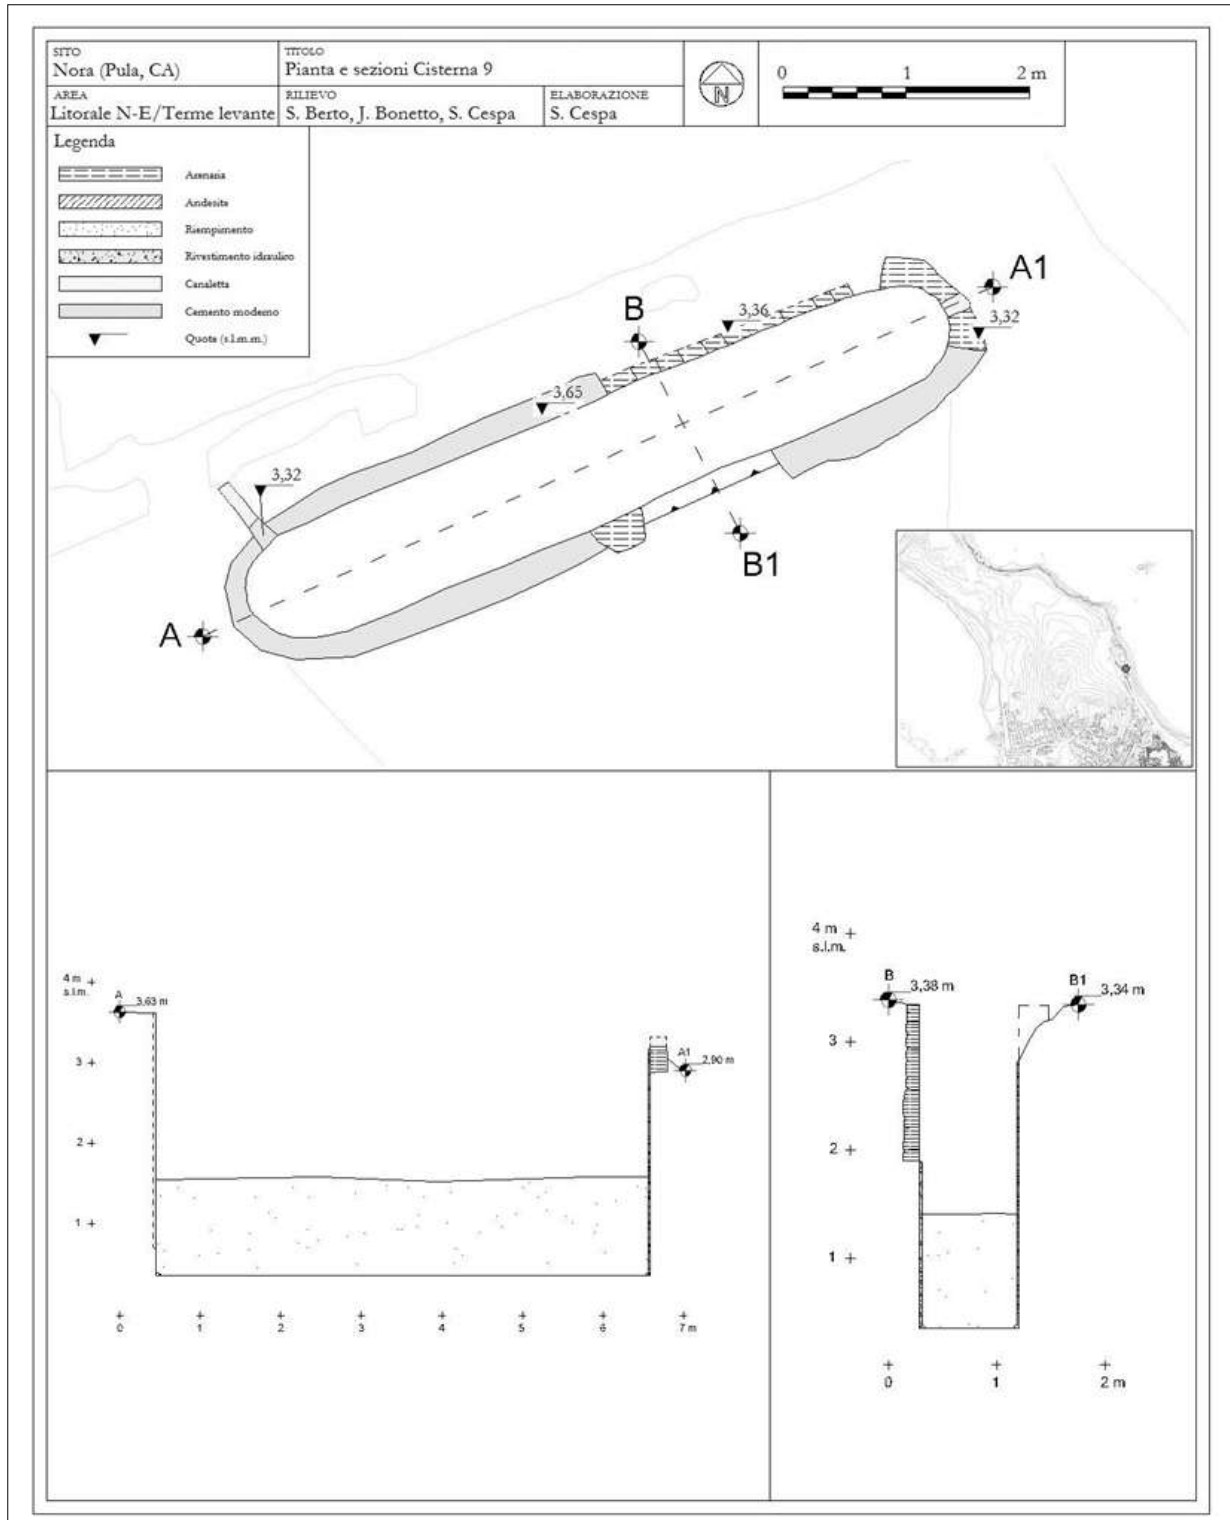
Pianta e sezioni della cisterna 9 (elaborazione dell'autore).
